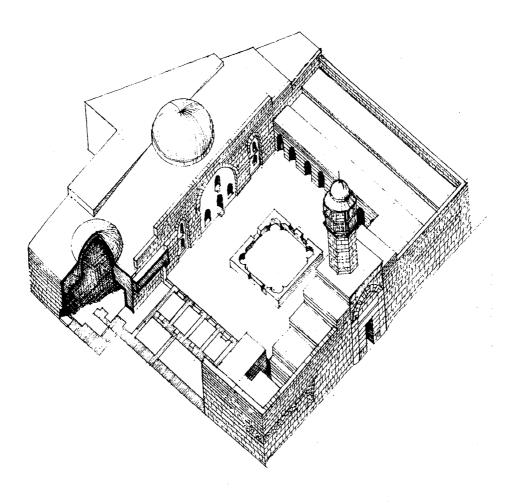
مسقط أفقي لمدرسة شادبخت في حلب ٥٨٩هـ/١١٩٣م (عن: كريزول) .
